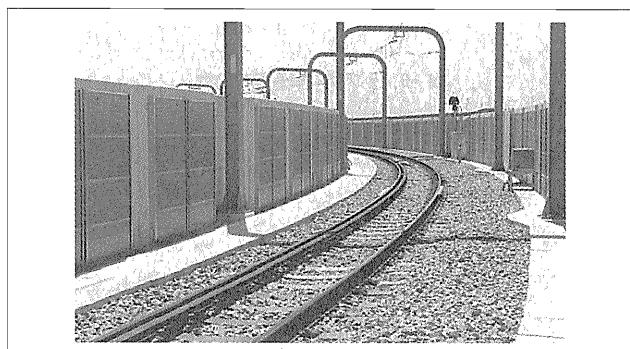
テプサム吸音壁「貼付けタイプ」の車両基地出入庫線への施工
